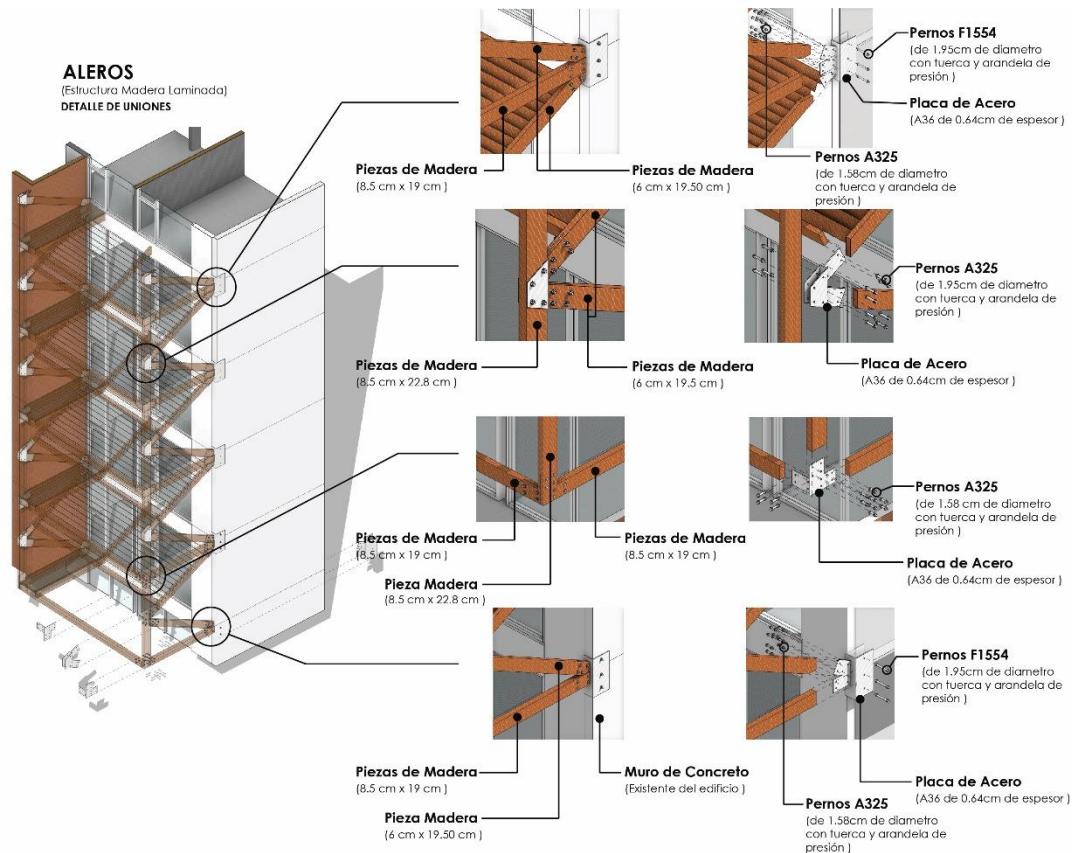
Detalle de piezas y uniones en aleros. Fuente: Elaboración propia
